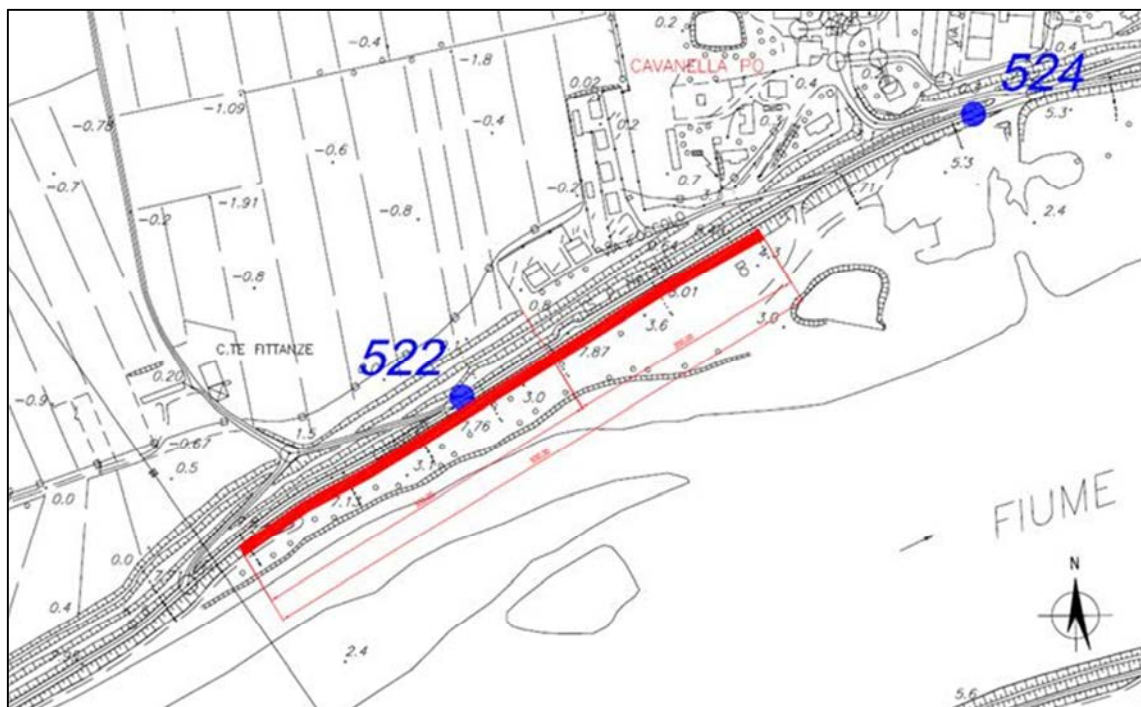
Planimetria con posizione della diaframmatura (sviluppo 500 m)
